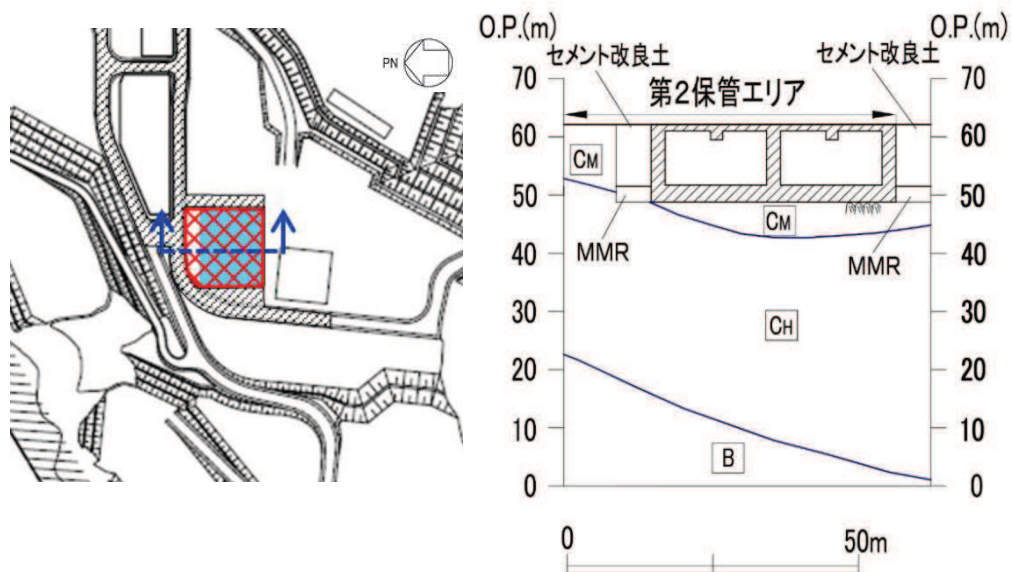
第2保管エリアの平面図及び地質断面図
